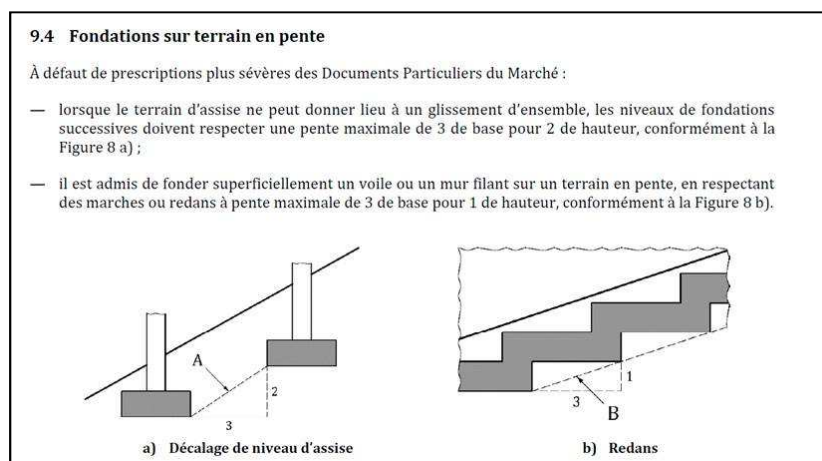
Schéma de principe pour les fondations à niveaux décalés - Extrait DTU 13.1
